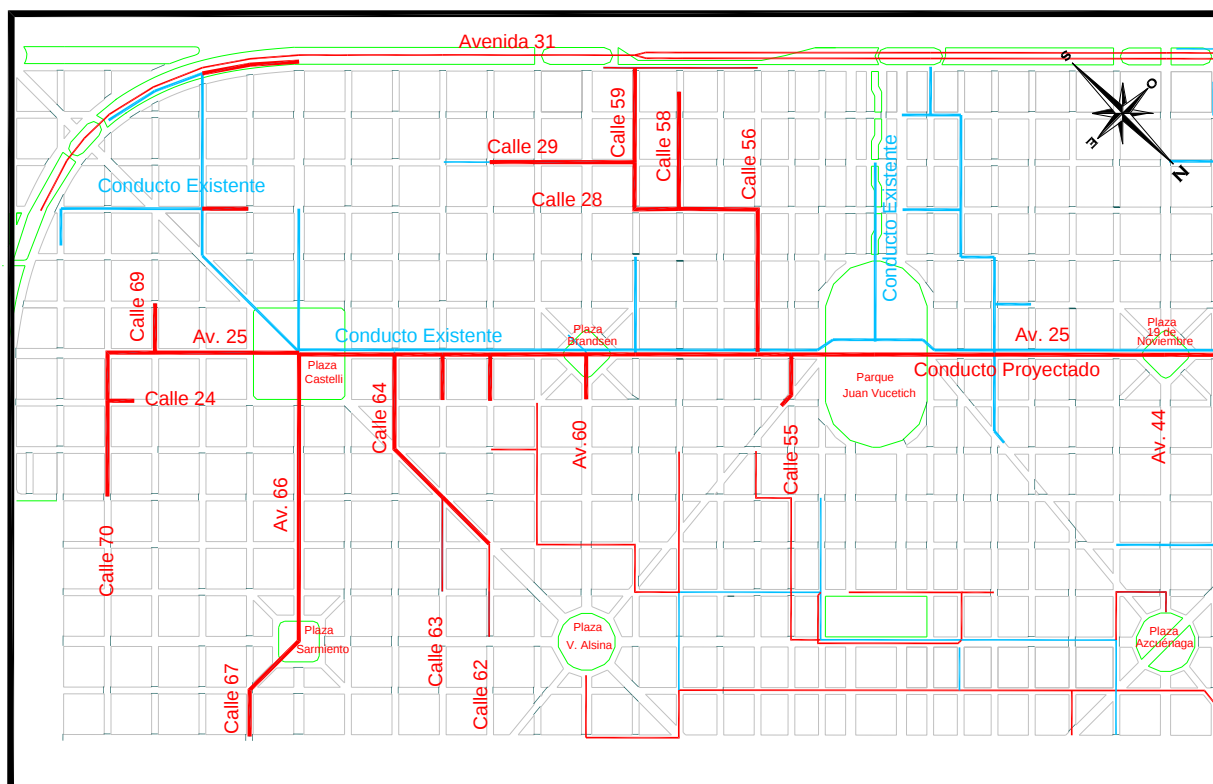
Detalle de la traza del conducto hasta la Avenida 44
